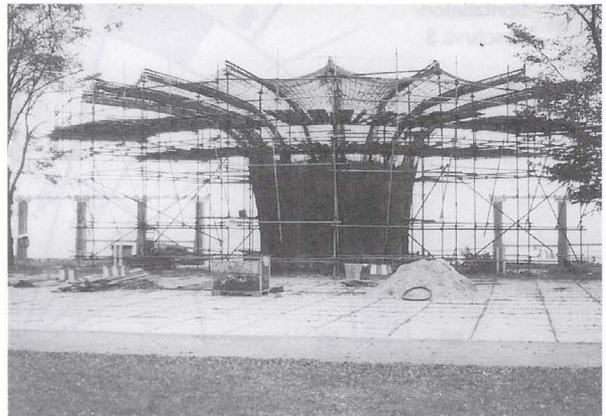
Abgehängte Bewehrung des Musikpavillon Saßnitz
